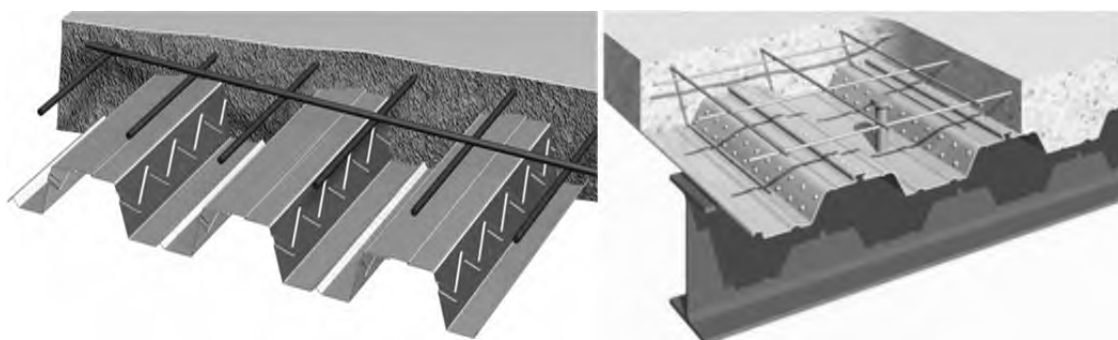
Монолитные перекрытия с несъемной опалубкой из профнастила
